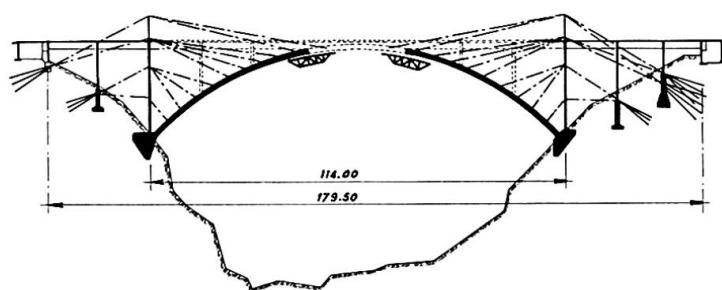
Construction du SCHWARZWASSERBRÜCKE
